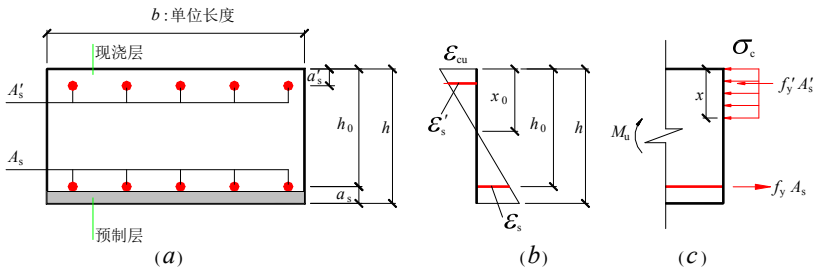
双筋矩形截面（叠合楼板）计算简图
